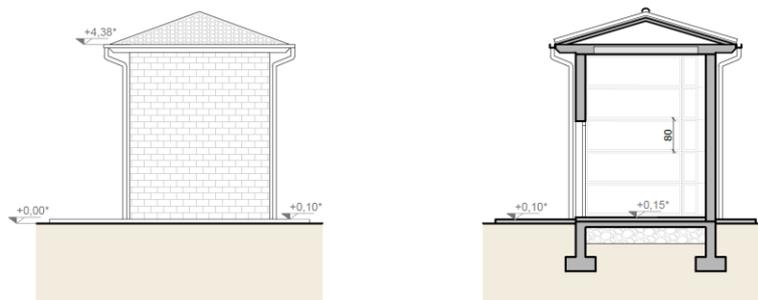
Prospetto laterale e sezione cappelle di famiglia
